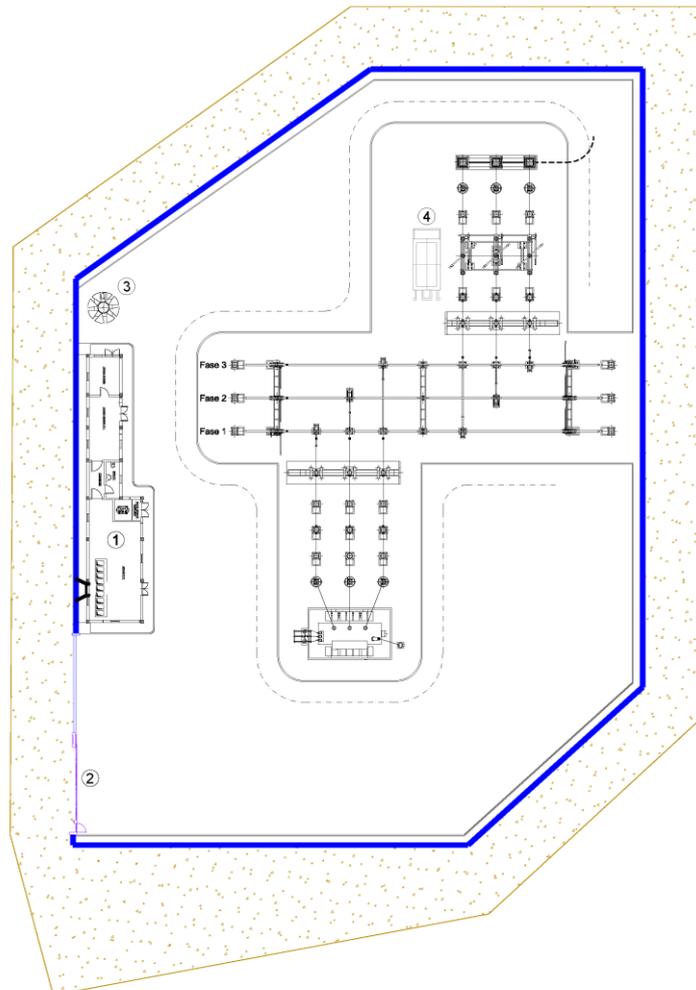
Planimetria elettromeccanica della Stazione Trasformazione Falck
